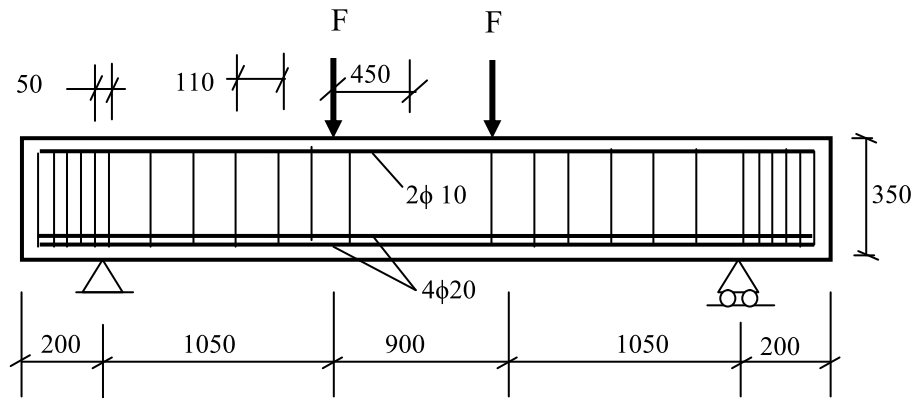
Dimensions et détails de ferrailage ; essais Stuttgart [101].
